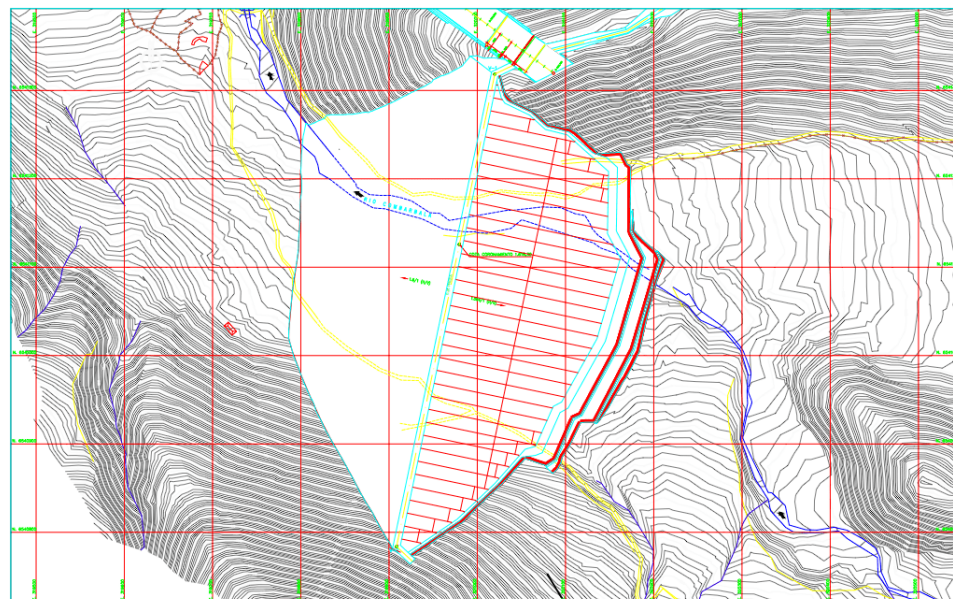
Planta Presa CFRD Murallas Viejas, Fuente: E.F MN ingenieros
